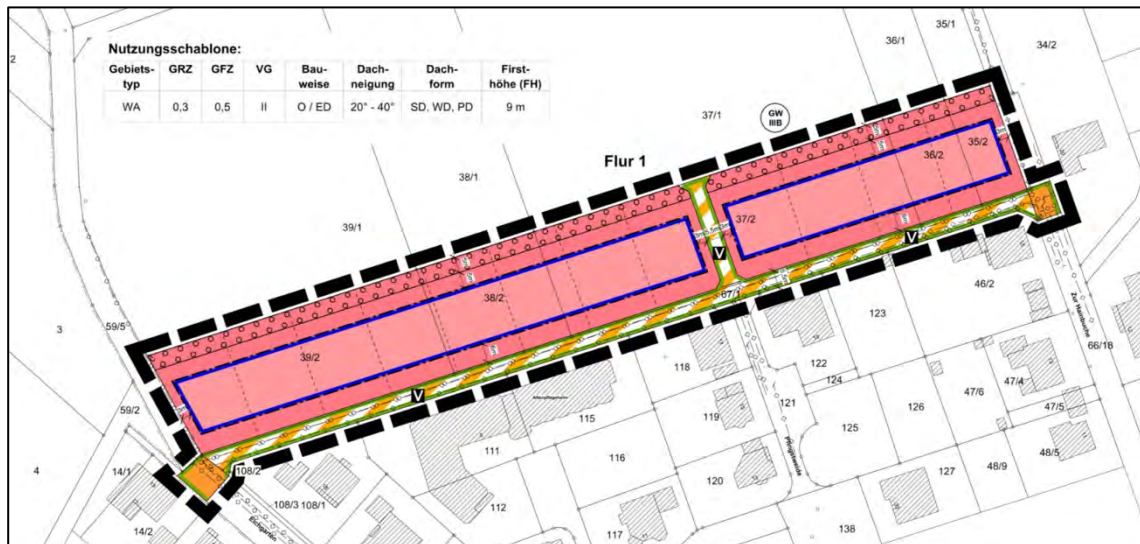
Bebauungsplan – Planteil Baugelände, Teilungsbereich I
